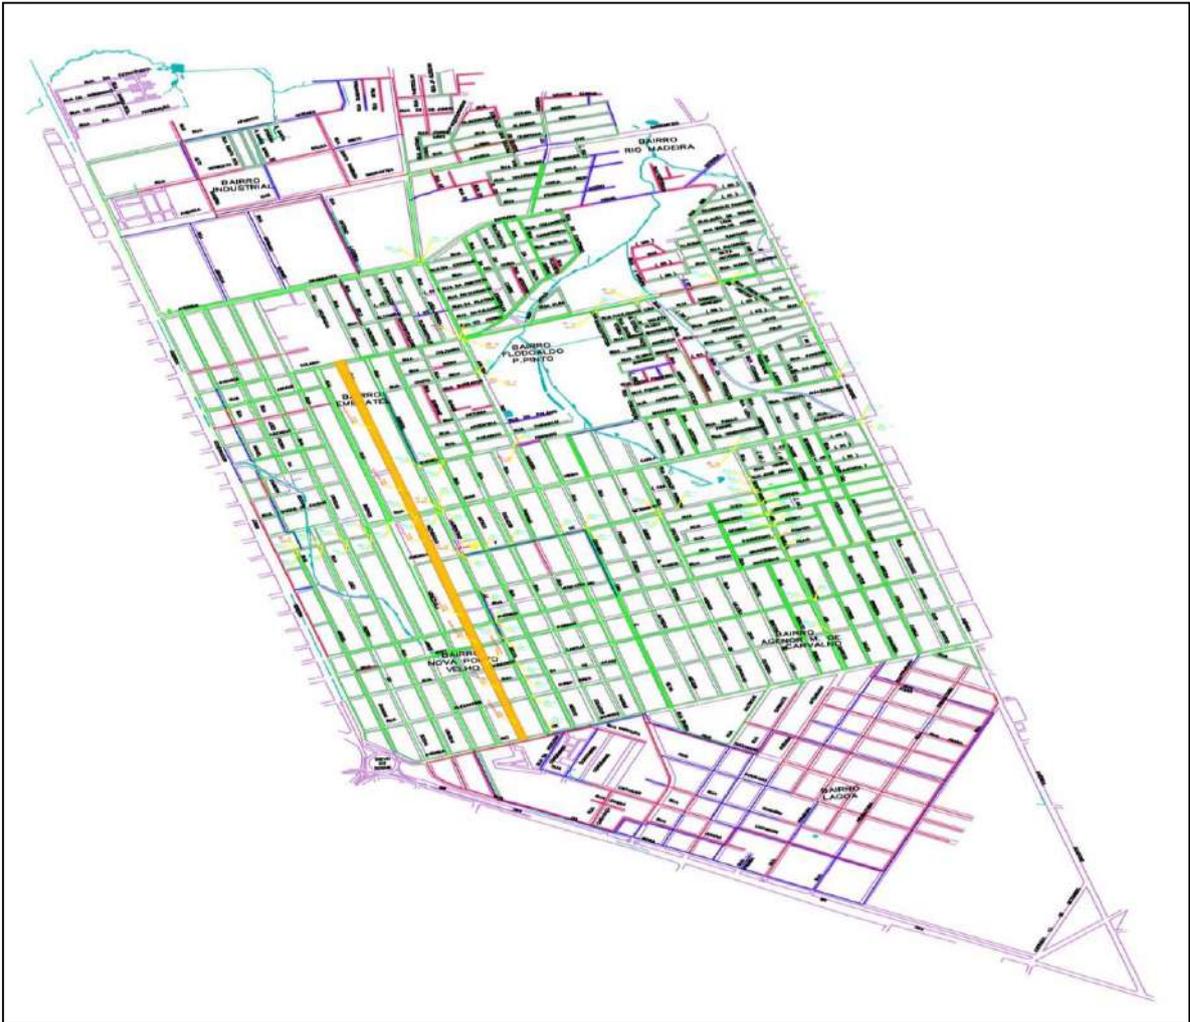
Planta da rede do sistema de abastecimento do CR-1
